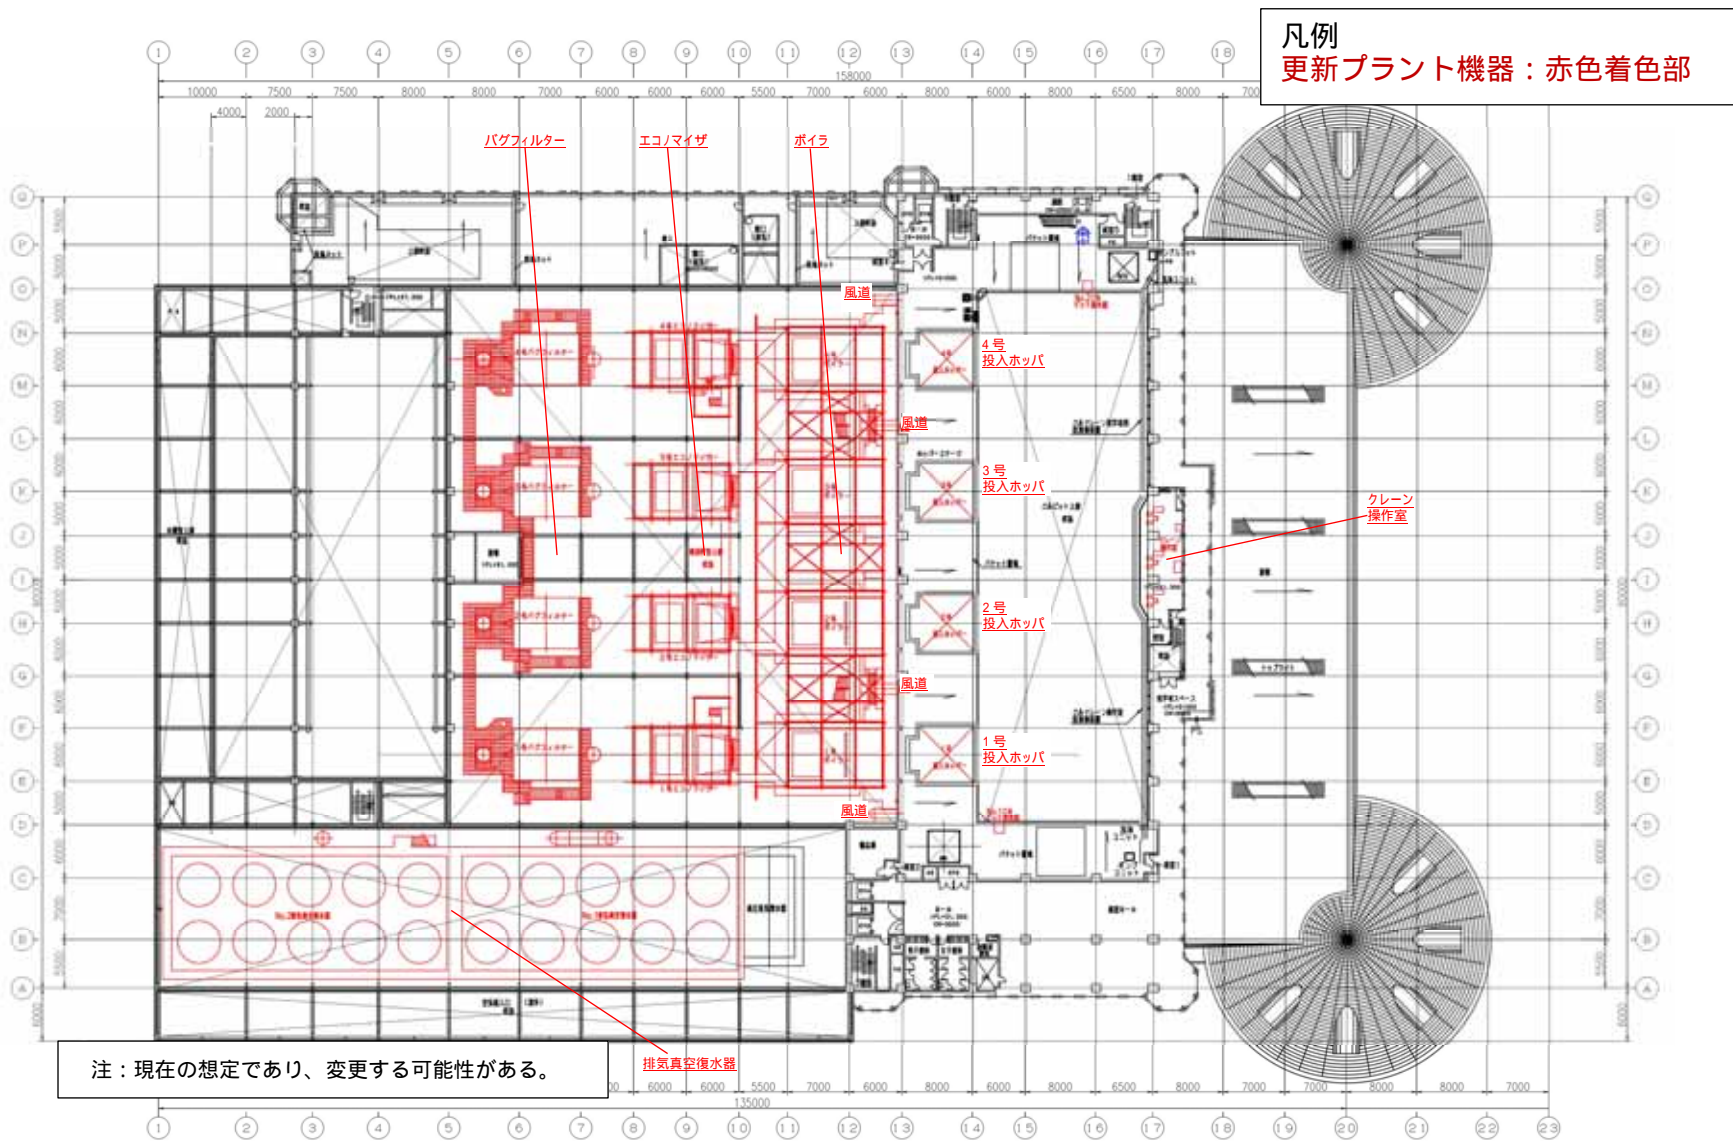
(7) 設備機器の更新箇所（8階平面図）
